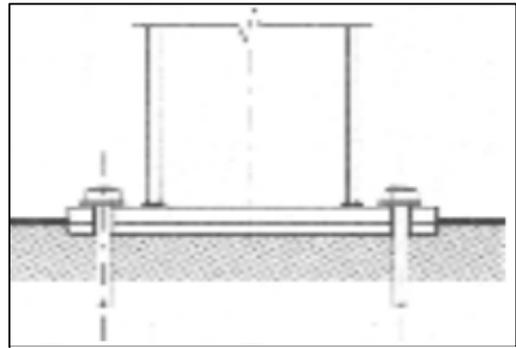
Assemblages poteaux poutre source : [beton/https://www.toutsurlebeton.fr/mise-en-oeuvre/le-radier-de-fondation-en-beton](https://www.toutsurlebeton.fr/mise-en-oeuvre/le-radier-de-fondation-en-beton)
